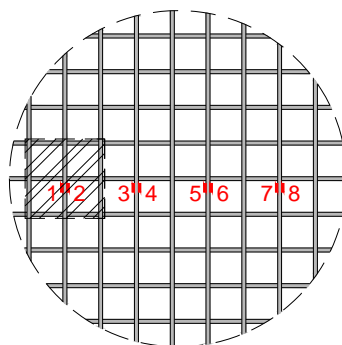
Posicionamento dos extensómetros na armadura longitudinal superior dos modelos.
